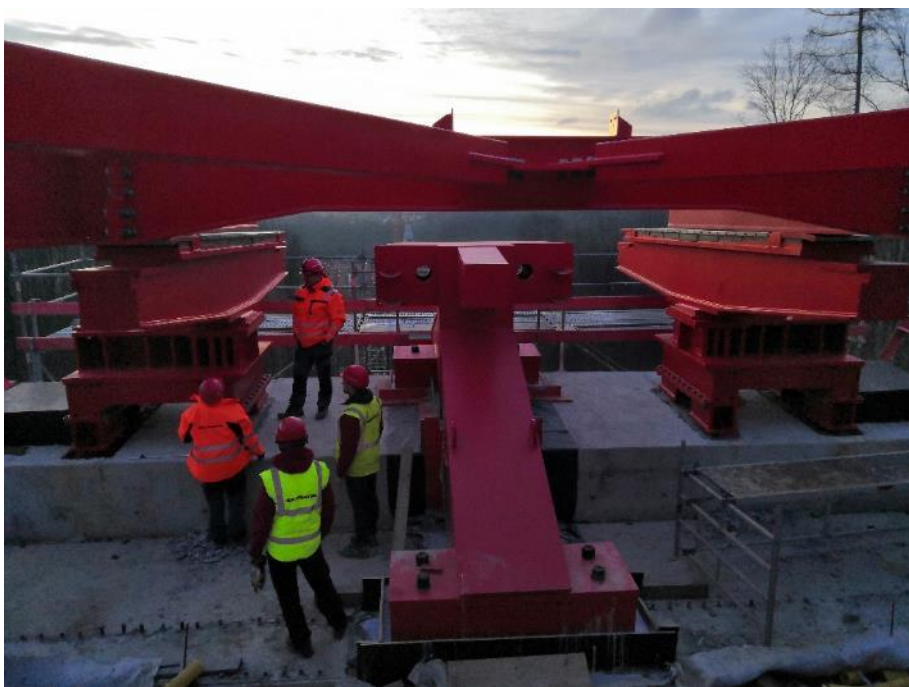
Detail výsuvného ložiska ve výsuvném dvoře
